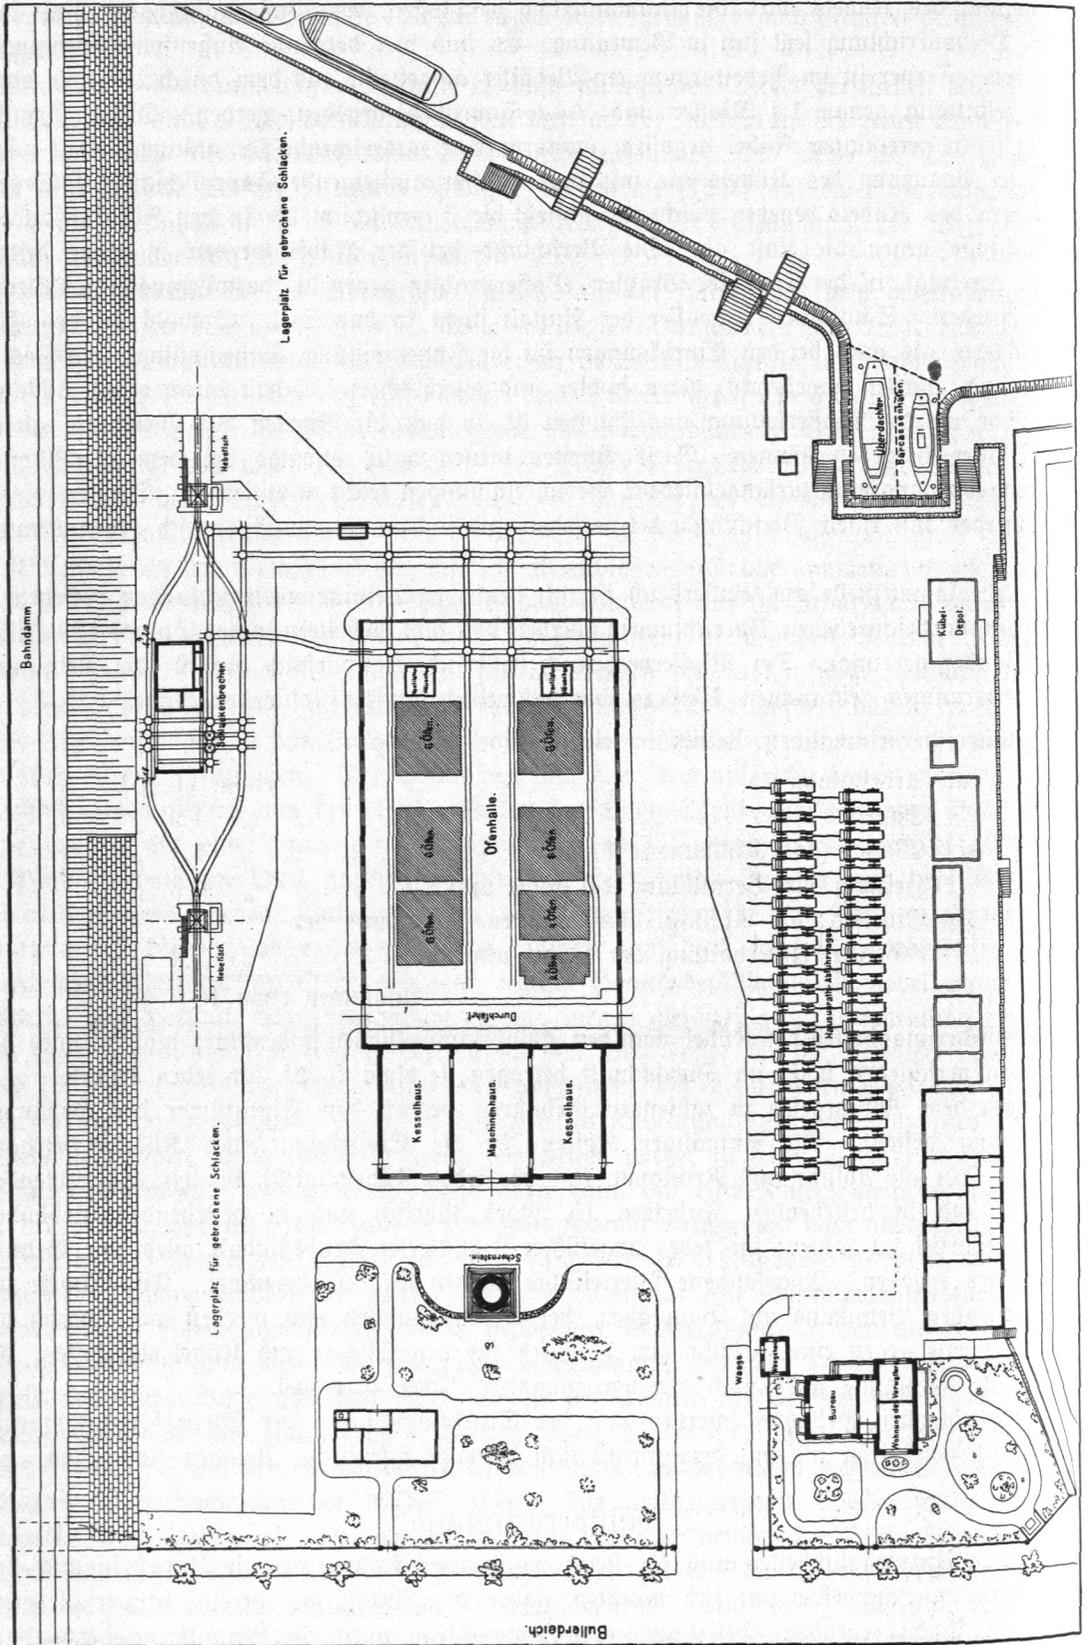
Verbrennungsaufbau am Bullerreich, Lageplan.
